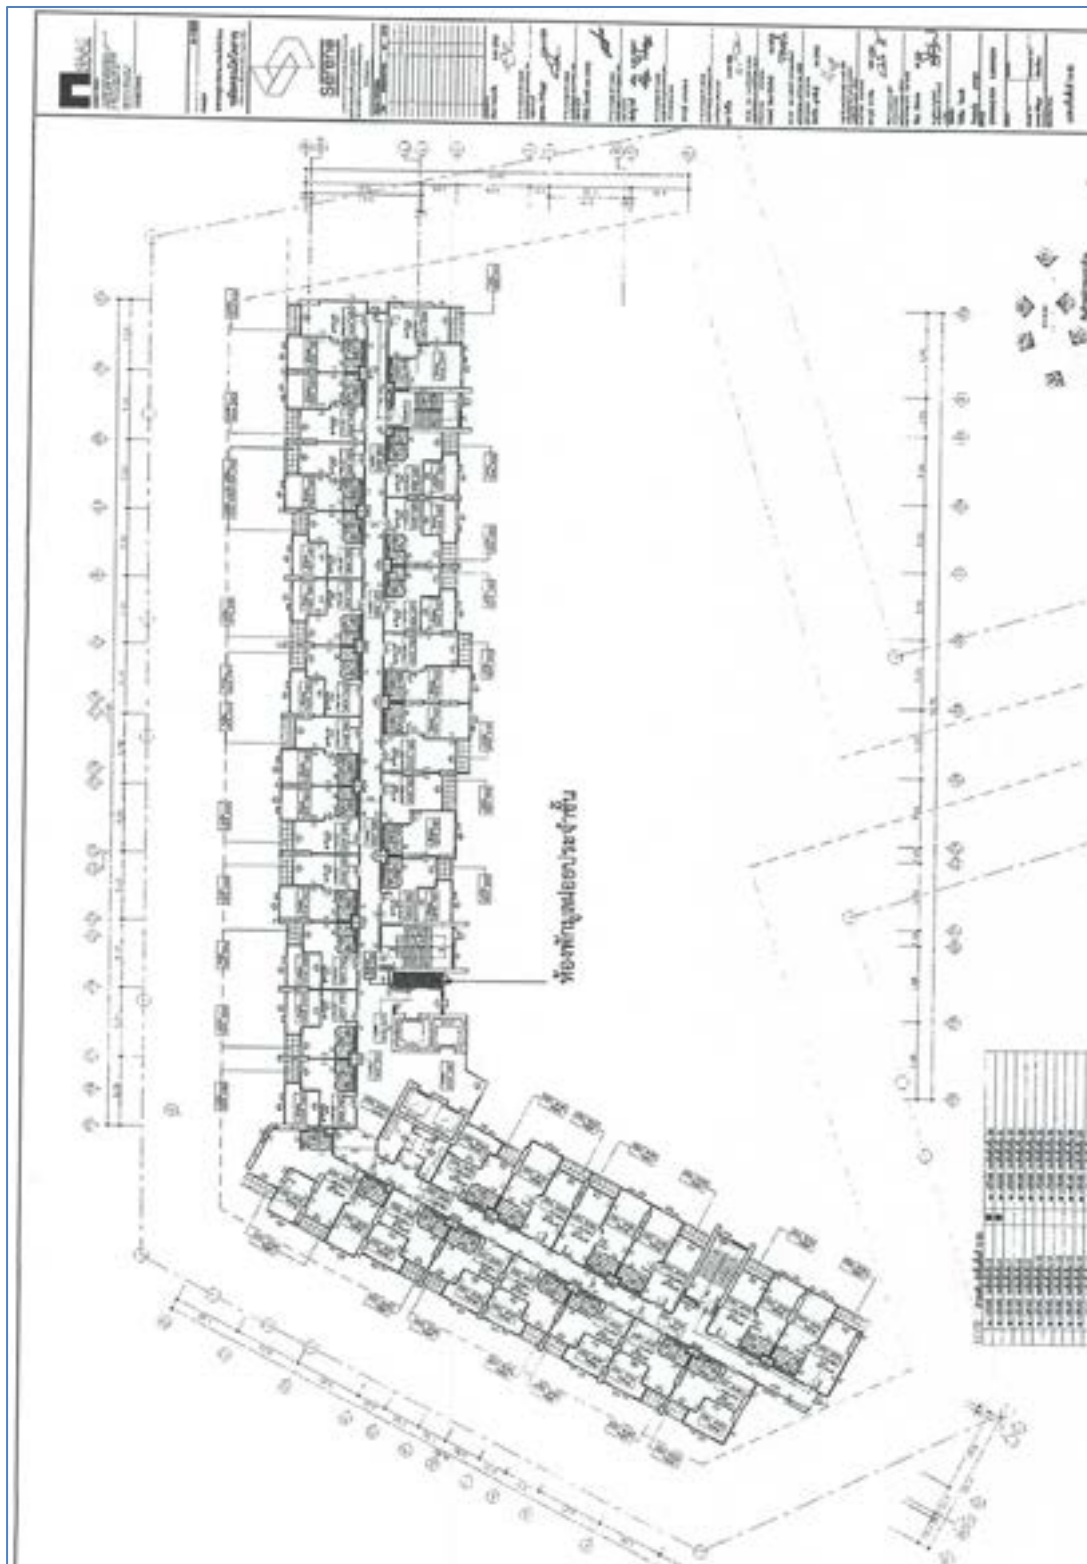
ผังระบบระบายรอบโครงการ
